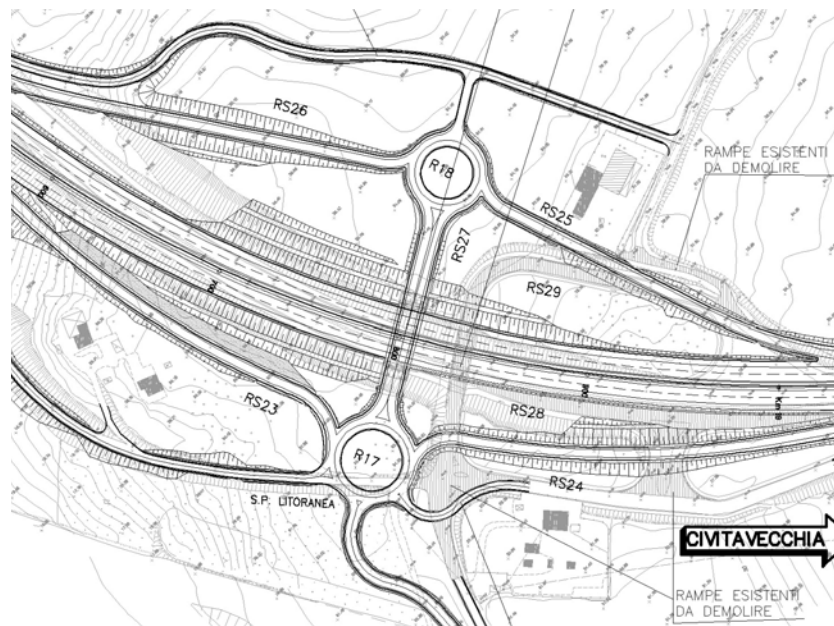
Svincolo di Riva dei Tarquini - Planimetria di Progetto
